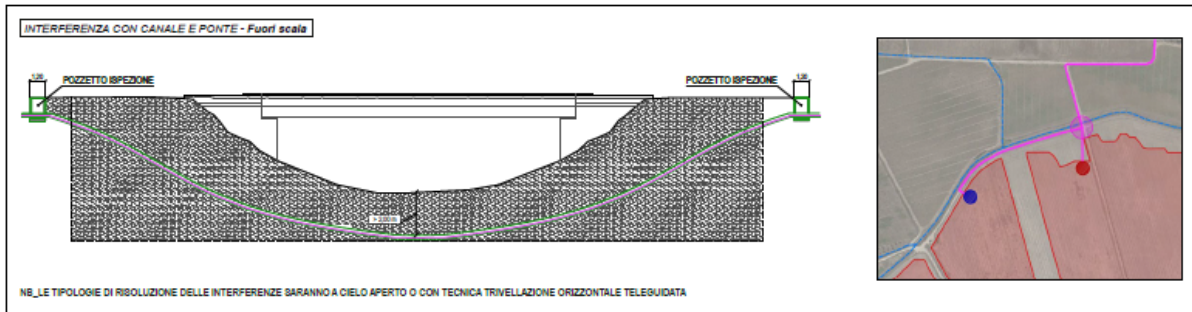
Interferenza n° 1 - attraversamento canale a ponte con tecnica T.O.C.
